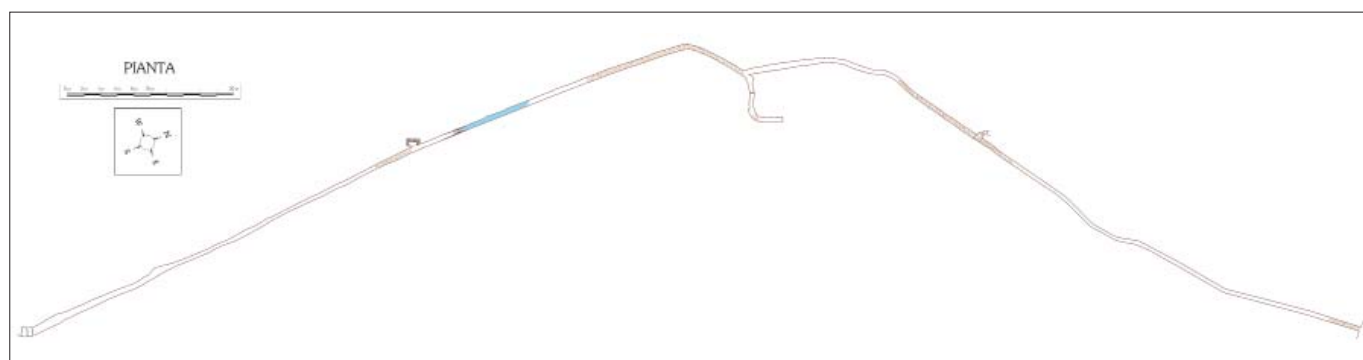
Planimetria del sistema ipogeo "Kolymbethra – Porta V"
